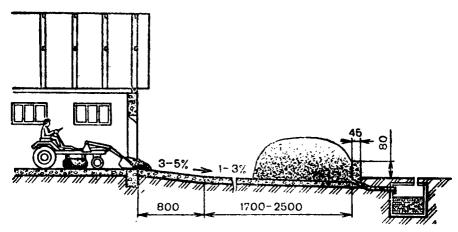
Схема устройства бетонированной площадки при удалении навоза бульдозером
